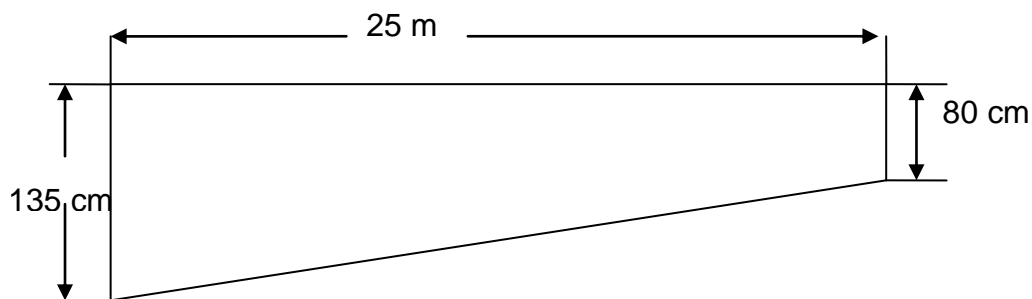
Längsschnitt durch das Nichtschwimmerbecken
